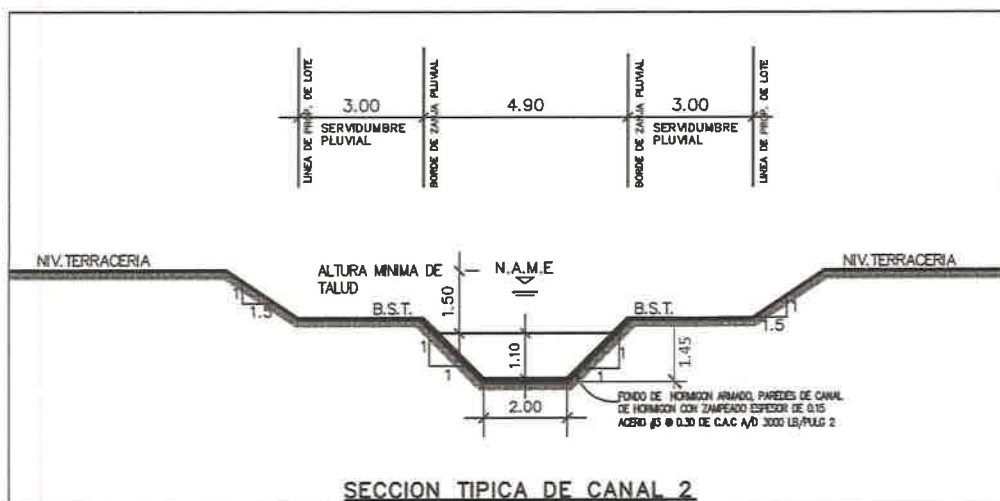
y 14: Extracto del plano para la sección longitudinal conformada en concreto, propuesta para el drenaje pluvial "Sin Nombre 2"
